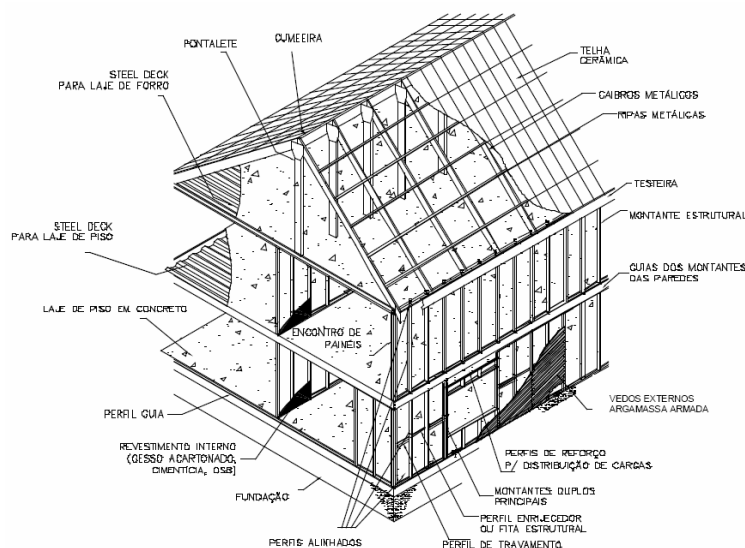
Modelo esquemático do sistema *Light Steel Framing*. Fonte: CEF, 2003, p. 7.
